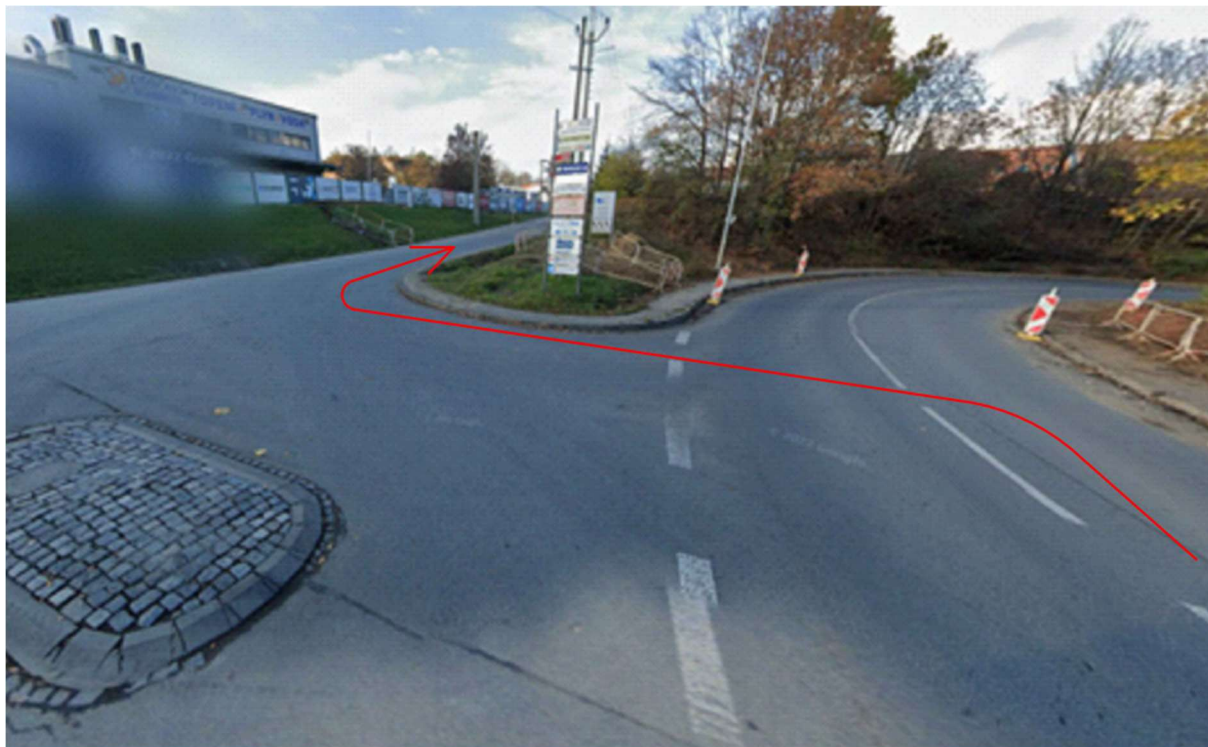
[10] Doprava pilotovací souprava z firmy na stavbu
